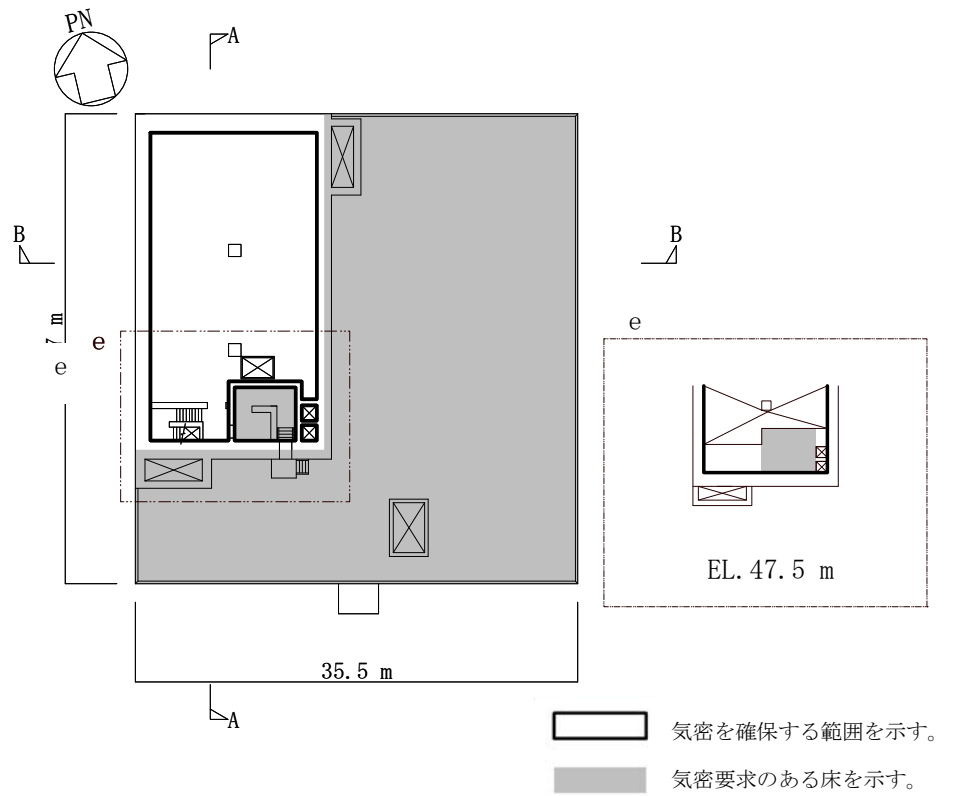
(4/7) 気密性を確保する範囲 (4 階平面図 : EL. 43.5 m)
